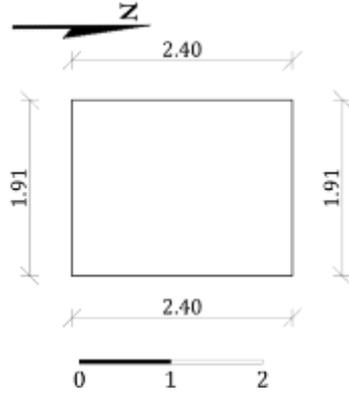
مسقط أفقي للمنور الجنوبي بدهليز المدخل بمدرسة قايتباي بالقرافة (عمل الباحثة)
